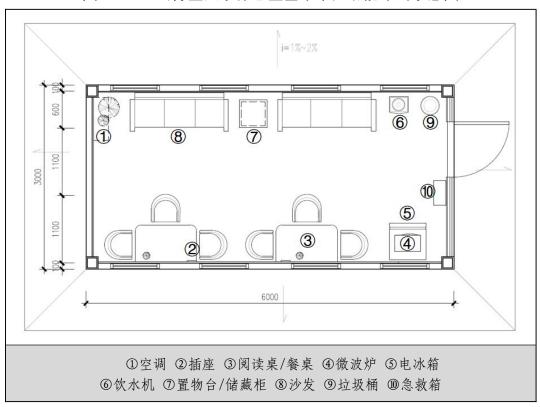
飞行区共享休息区基本单元平面示意图(单位: mm)
